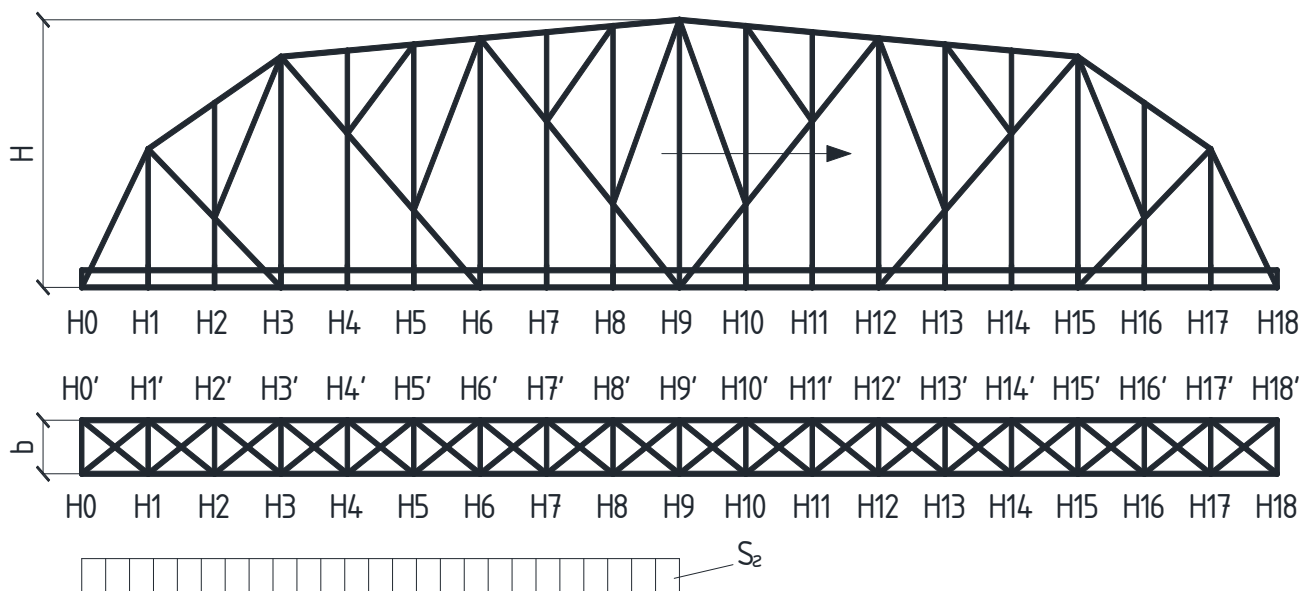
Епюра зусиль від гальмування в елементах нижнього поясу ферм
